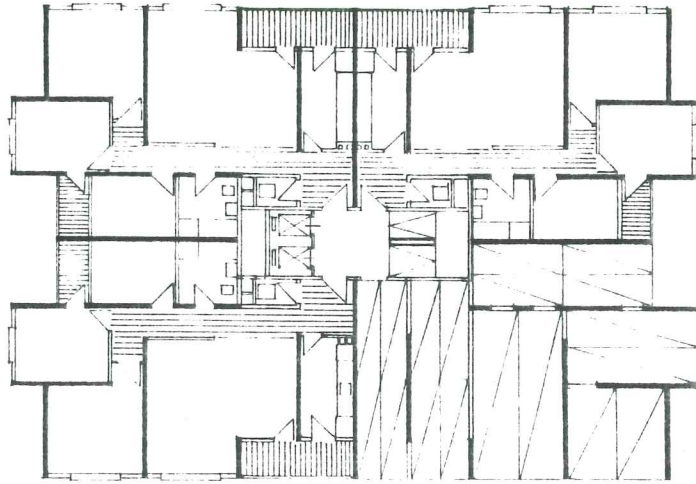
Tünel kalıplarla yapılan çeşitli plan tipleri.
